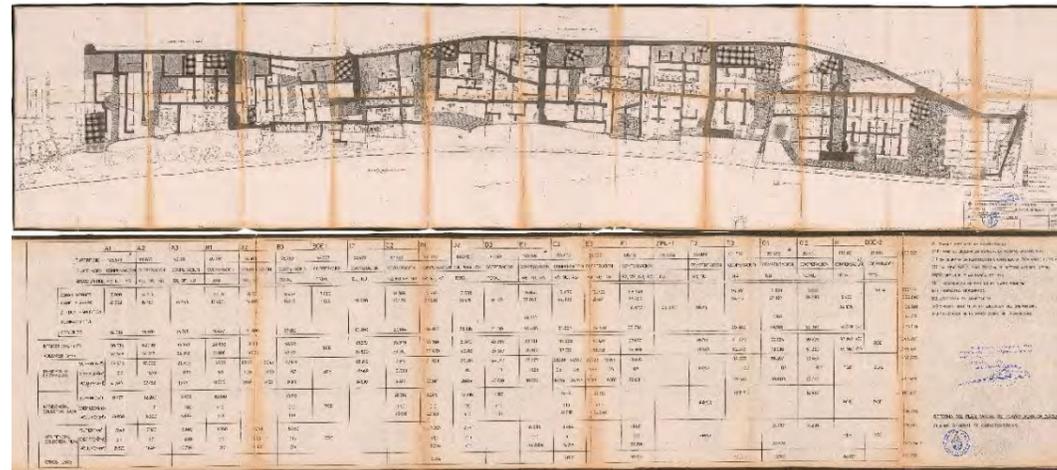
Plan de Playas de Almadá. Fuente: Ayuntamiento de Sagunto (Noviembre de 1982)
